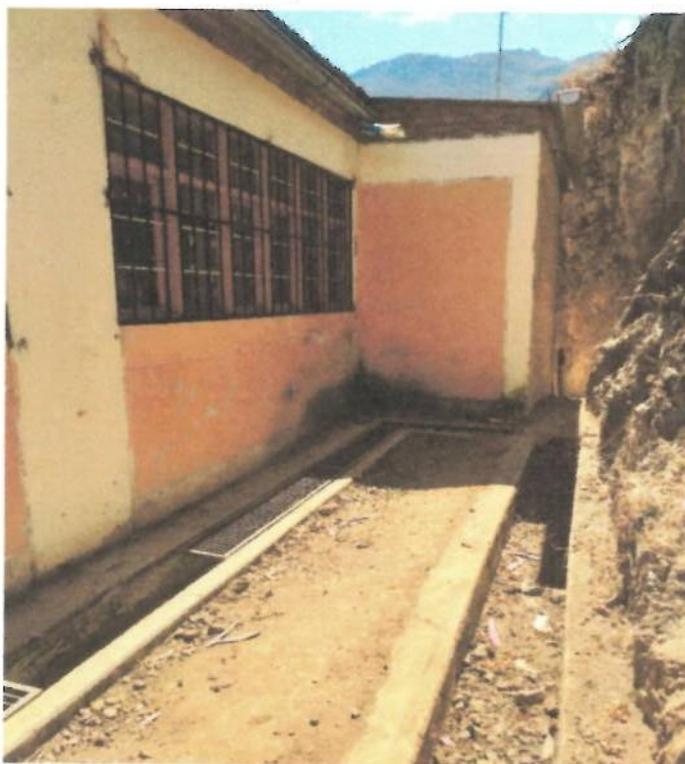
vista exterior de la parte posterior de la edificación, los elementos estructurales no presentan daños; sin embargo, se requieren trabajos de mantenimiento, colocación de tubería PVC bajada del drenaje pluvial del techo, reposición de tarrajeo en la parte húmeda se observa desprendimiento de tarrajeo.
